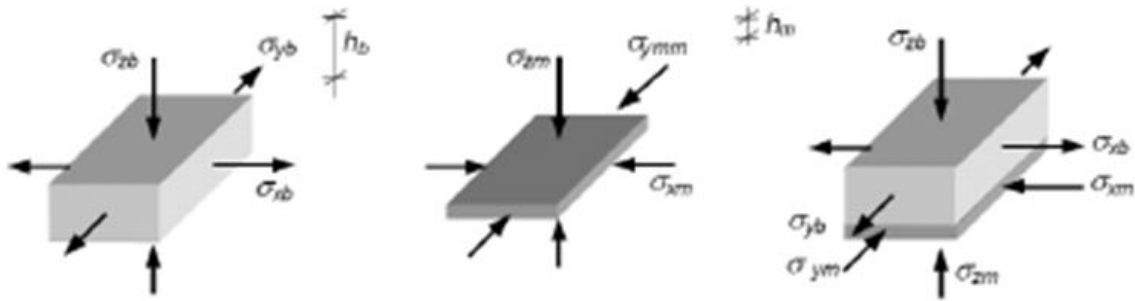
Estado de esfuerzos en la pieza y en el mortero que componen la mampostería cuando se encuentra sometida a compresión. Adaptado de (Vlviestas, 2009).
